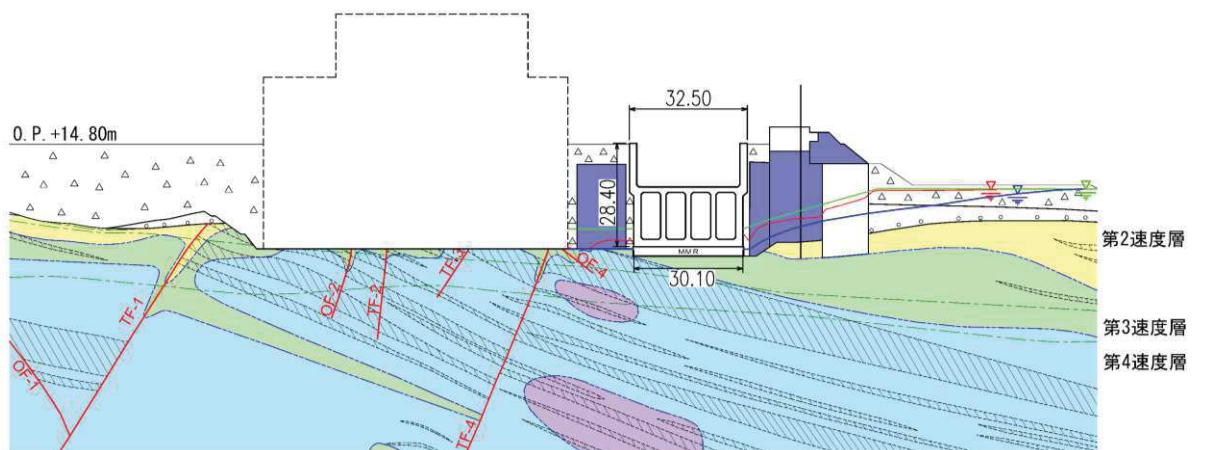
(2) 地質断面図 (海水ポンプ室)
